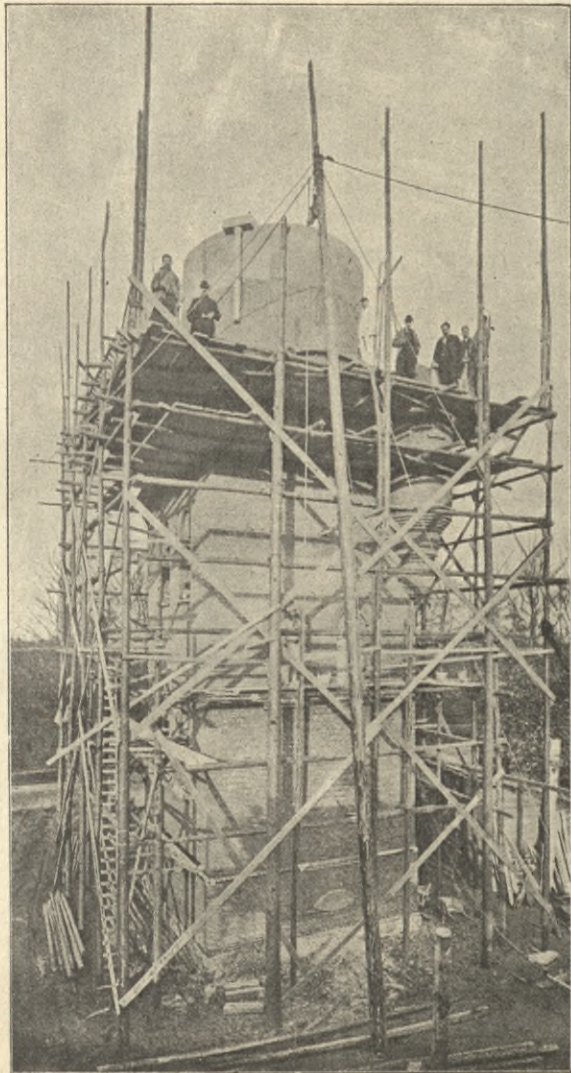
Wasserturm der Wasserleitung für Wageningen (Holland).
